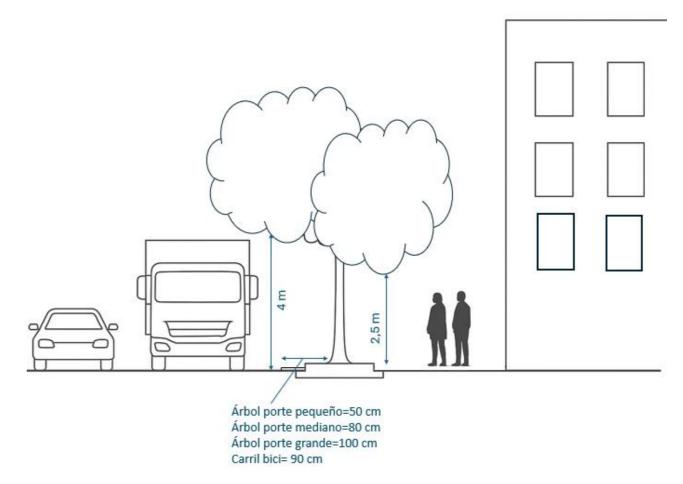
Croquis alturas de gálibo y distancia del tronco con la calzada/carril bici. Las distancias con fachadas dependen del porte del ejemplar como se ha visto más arriba. Fuente: Elaboración propia.
